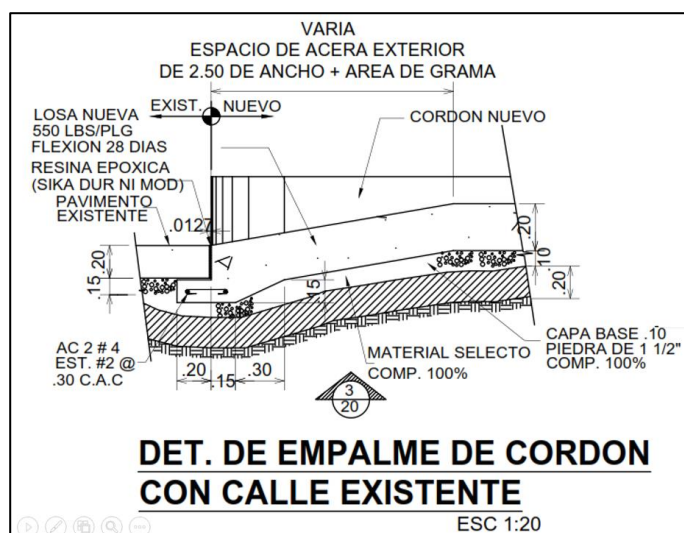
Detalle de empalme de cordón con calle existente.
